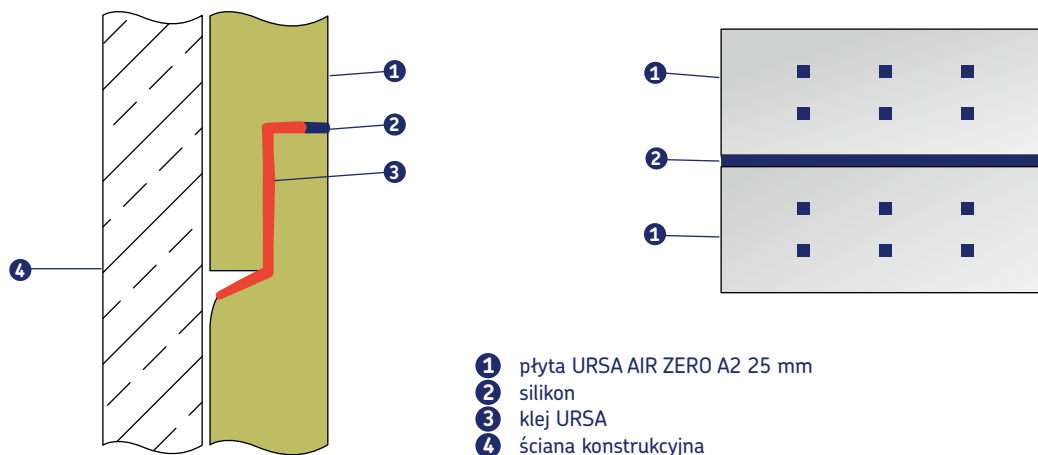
• Mocowanie płyt URSA AIR ZERO A2 do ścian konstrukcyjnych z betonu
